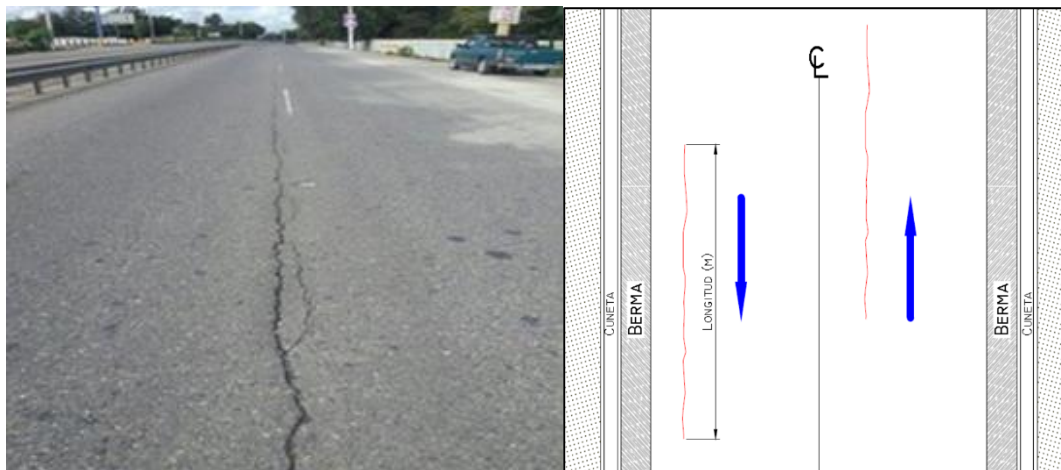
Fisuras longitudinales por fatiga (FLF).
